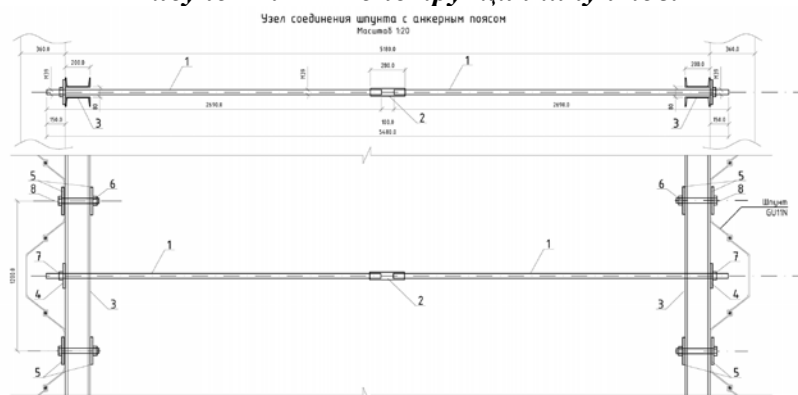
Узел соединения шпунта с анкерным поясом
